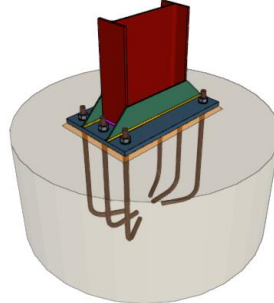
Placa de anclaje pilar interior (Unión tipo 15)
